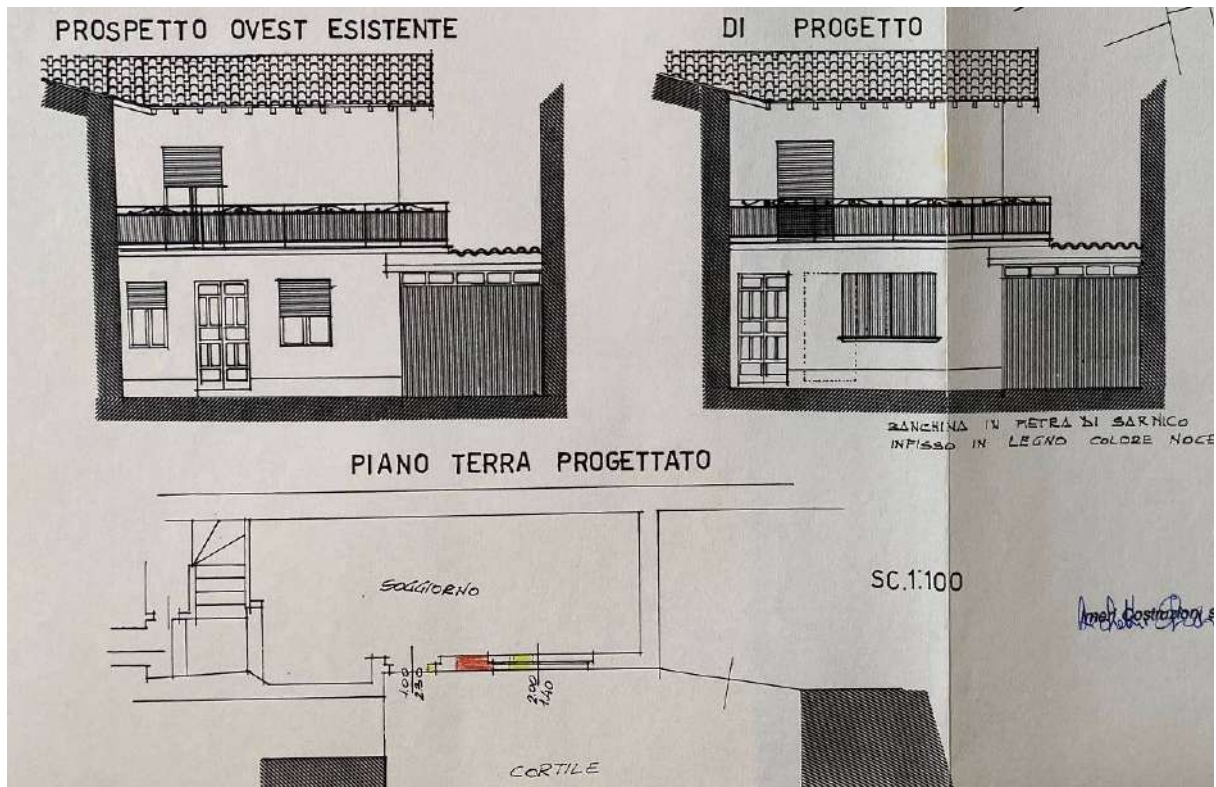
Estratto elaborato grafico della Autorizzazione Edilizia N. 52/92 Prot. 1821 del 25.03.1992
